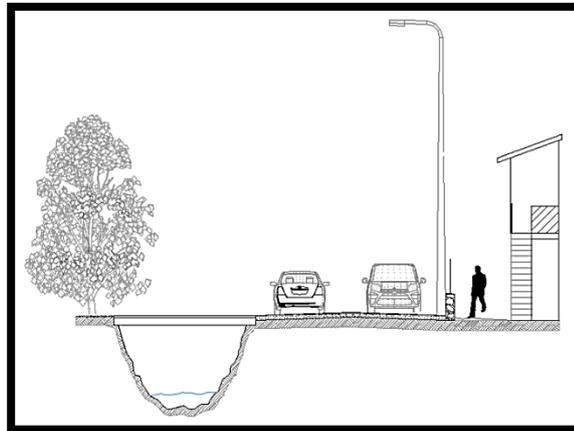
SECCIÓN DE LA CALLE 1 – TRAMO (T1 – T8)
